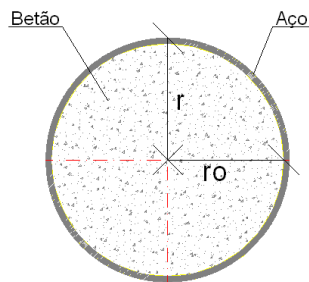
Secção das colunas tubulares de betão encamisado em aço
